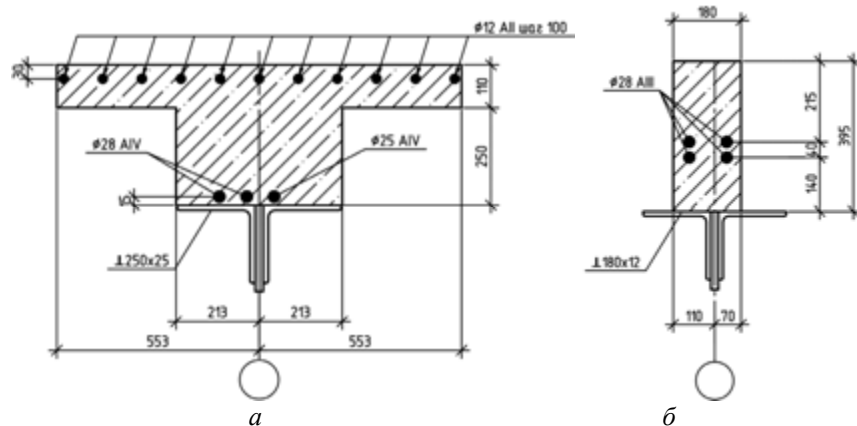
Расчетное сечение верхнего пояса фермы: *a* — верхний пояс главной фермы; *б* — верхний пояс второстепенной фермы
